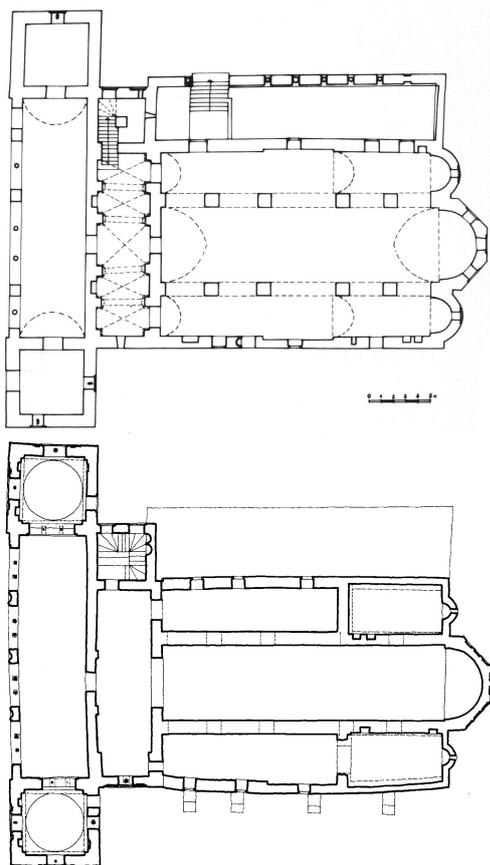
La iglesia de Santa Sofía después de la reconstrucción turca, s. XV-XVI. A: Planta baja y B: Planta superior.
